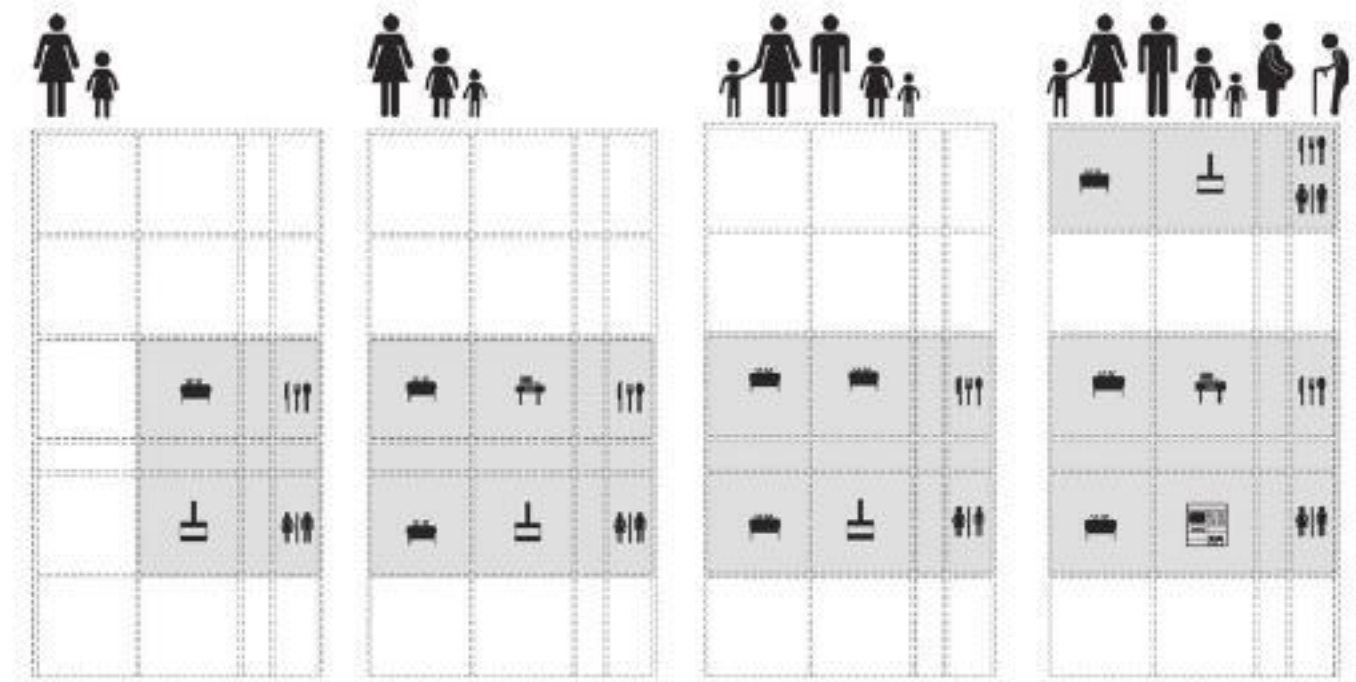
Caso 1. Plantas del desarrollo del plan de tránsito
